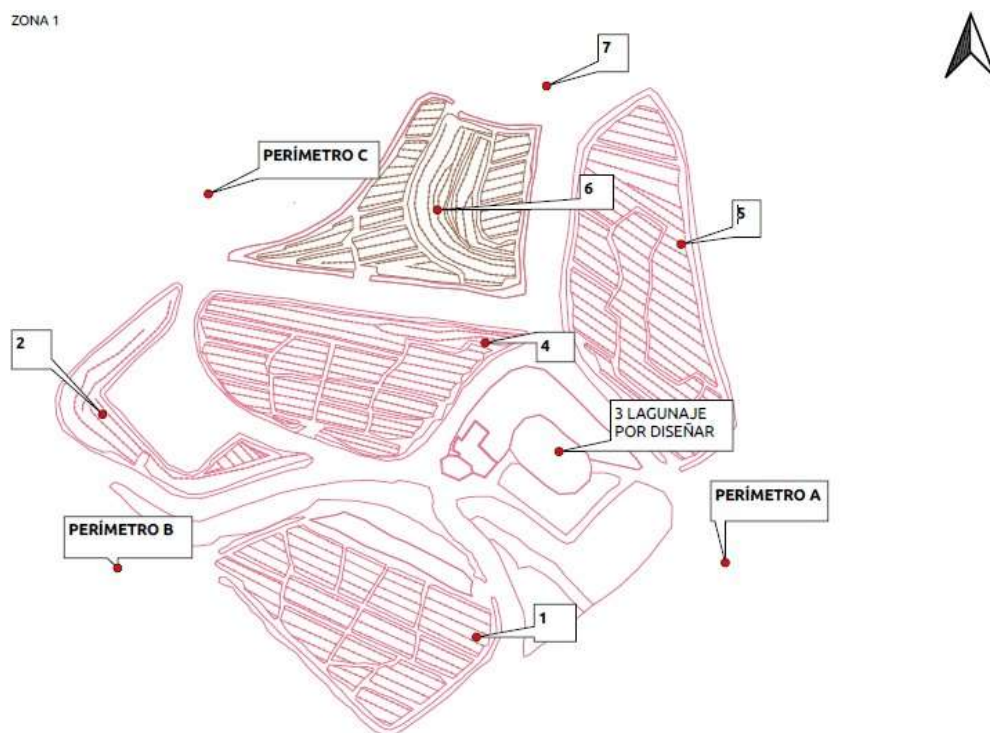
Plano Zona 1 Parque Central. Fuente: Ayuntamiento de Adeje
